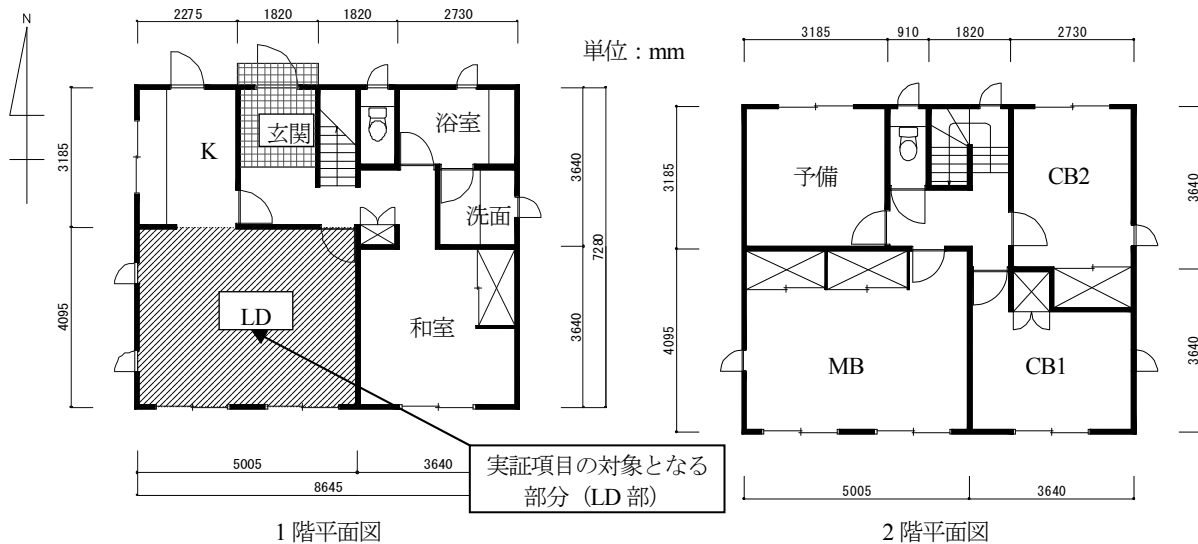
計算用住宅モデル (平面図)⁷⁾
